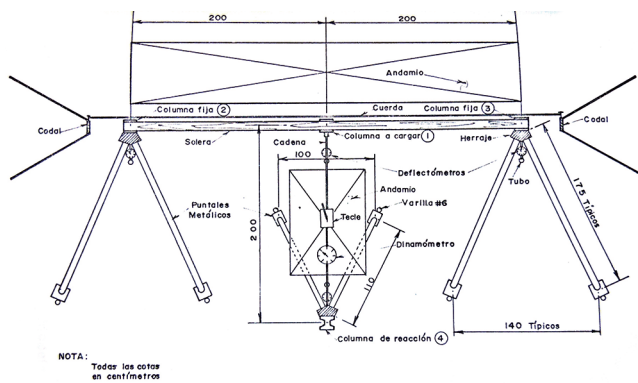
Detalle en planta montaje experimental del Modelo 1-A (Calvo, 1987).
